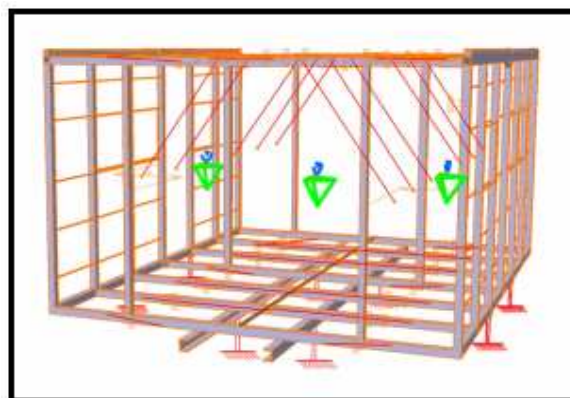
10: Detalle de unión de la estructura fija con las móviles
